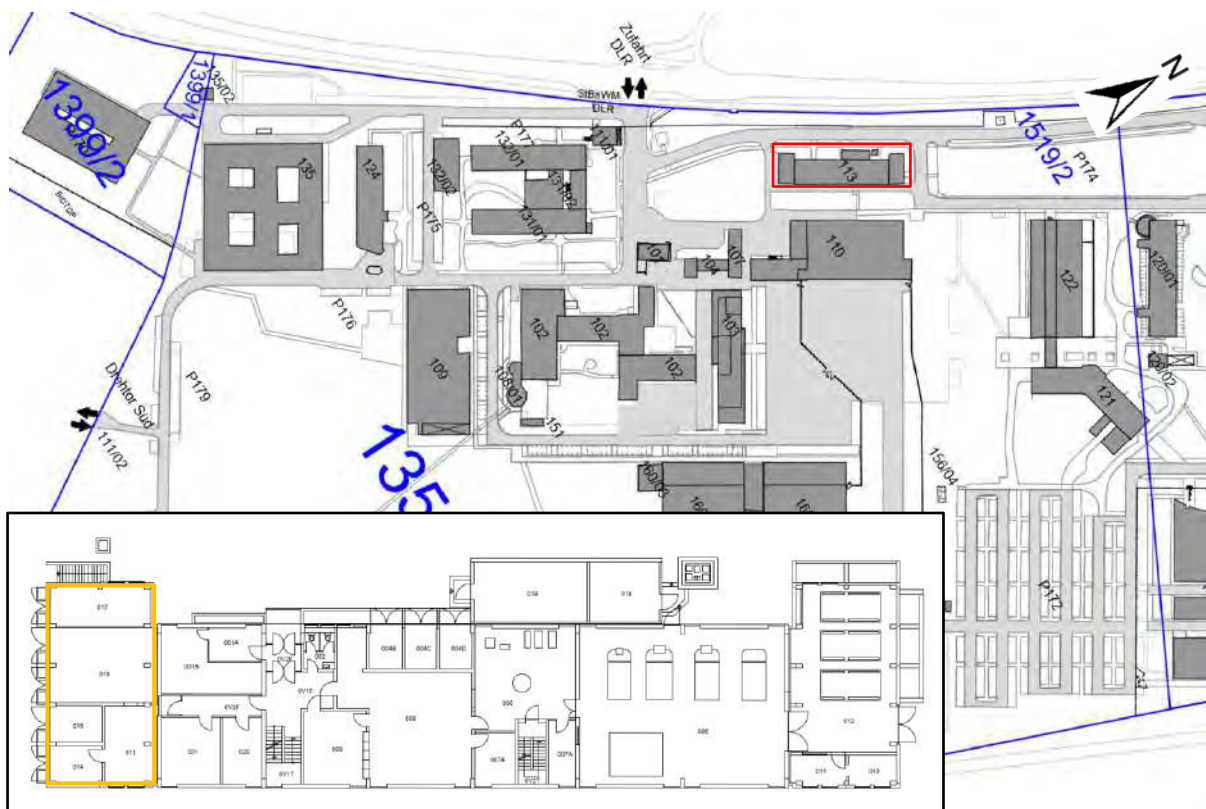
Lage von Gebäude 113 (rot). Ausschnitt aus [6]. Im EG-Grundriss Lage der KVF als orangene Markierung [23].
